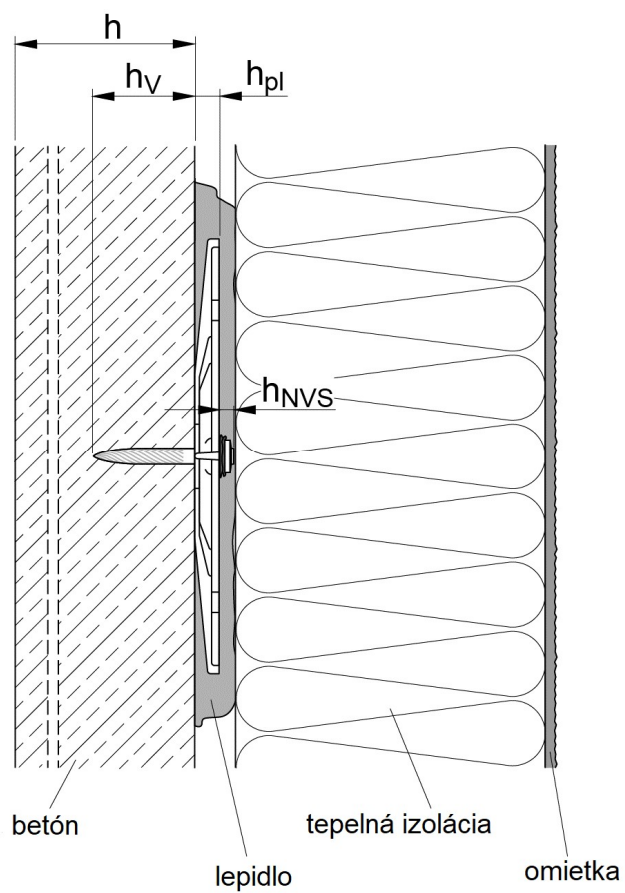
Kotviaci prvok zabudovaný v betóne bez povrchovej úpravy – typ A
